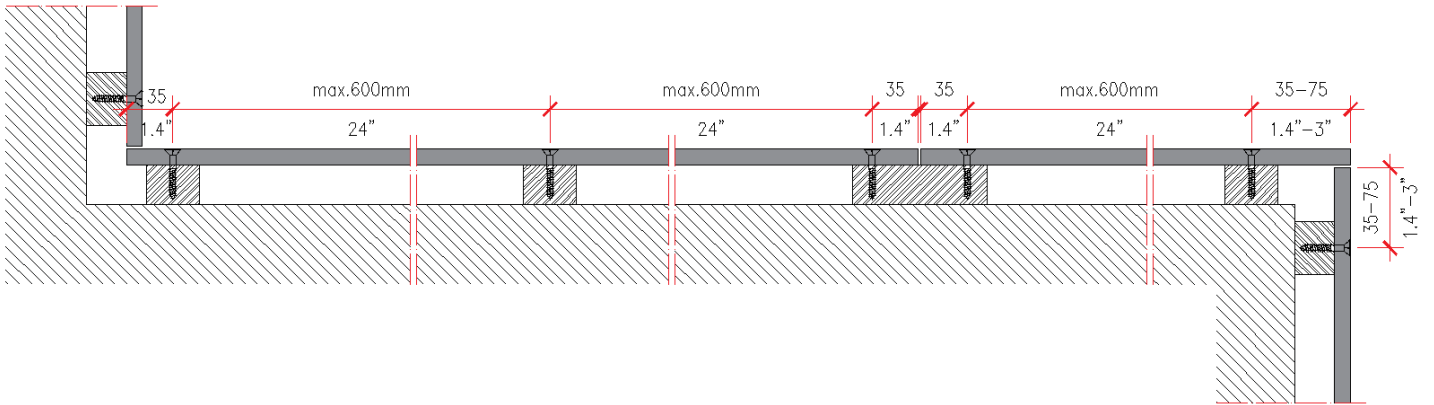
Secção horizontal de revestimento de parede, estrutura de madeira
